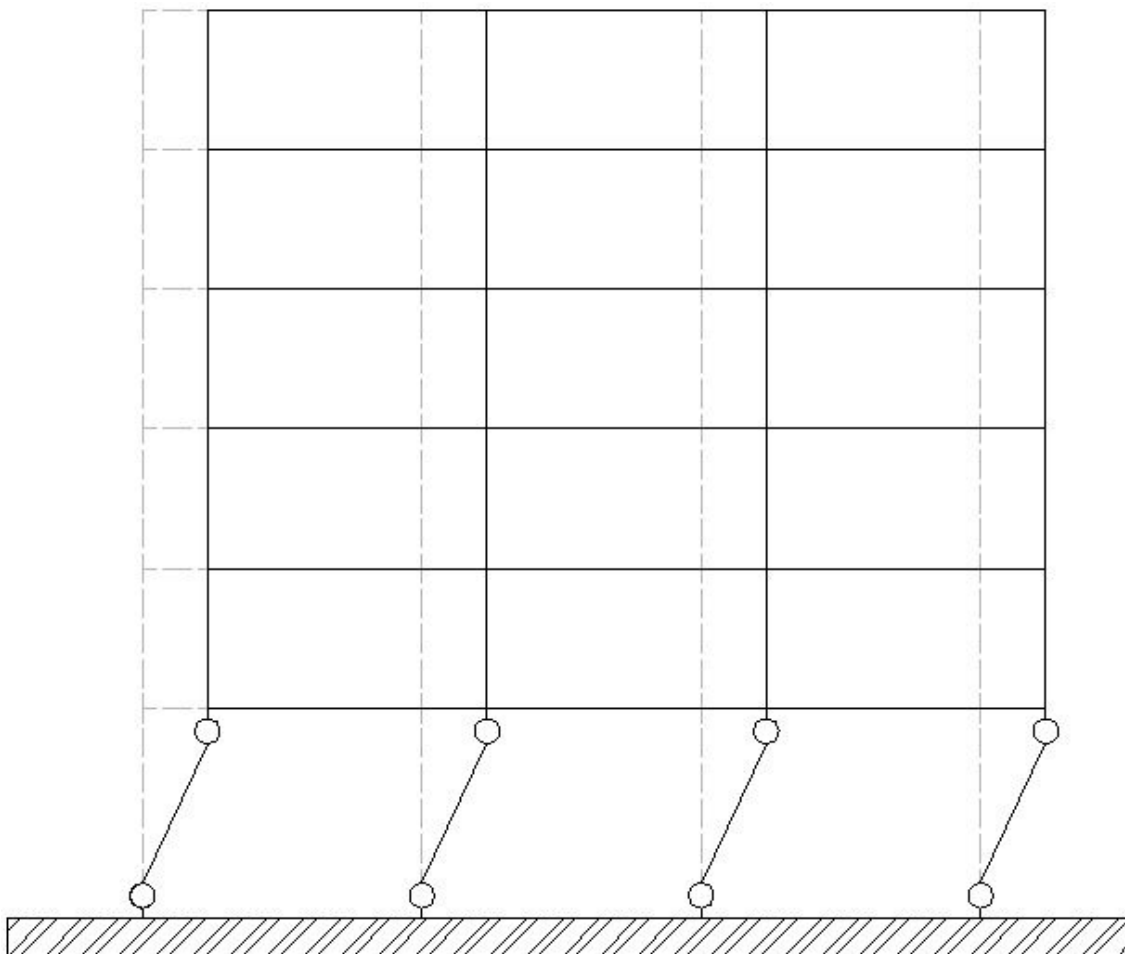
Estructura del tipo “columna débil – viga fuerte” con plastificación en planta baja
